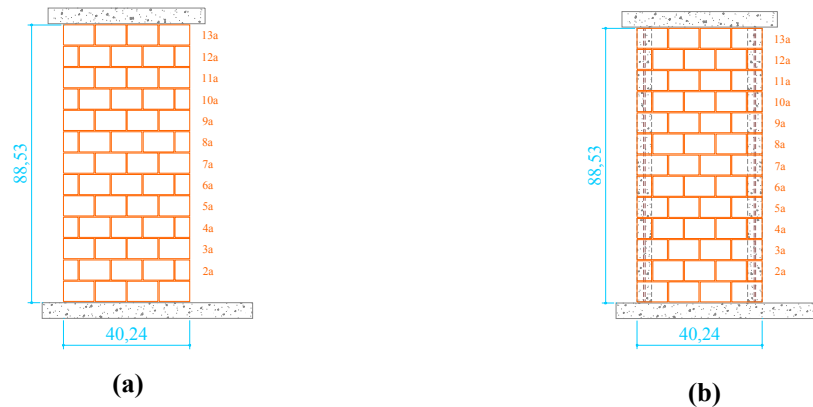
Painéis isolados: (a) Vista global e dimensões do painel sem armadura; (b) Painel grauteado e com armaduras. Medidas em centímetros.
